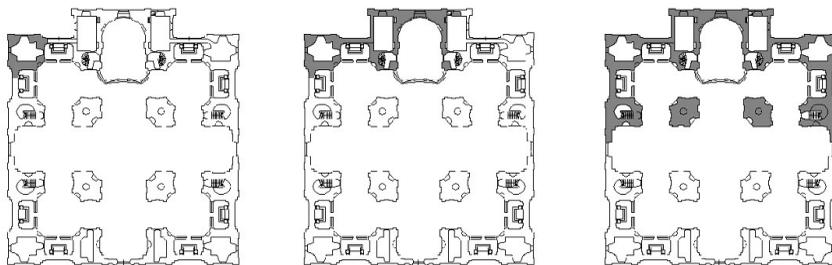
Planimetria della basilica, avanzamento dei lavori nel 1552, nel 1553 e nel 1558.
